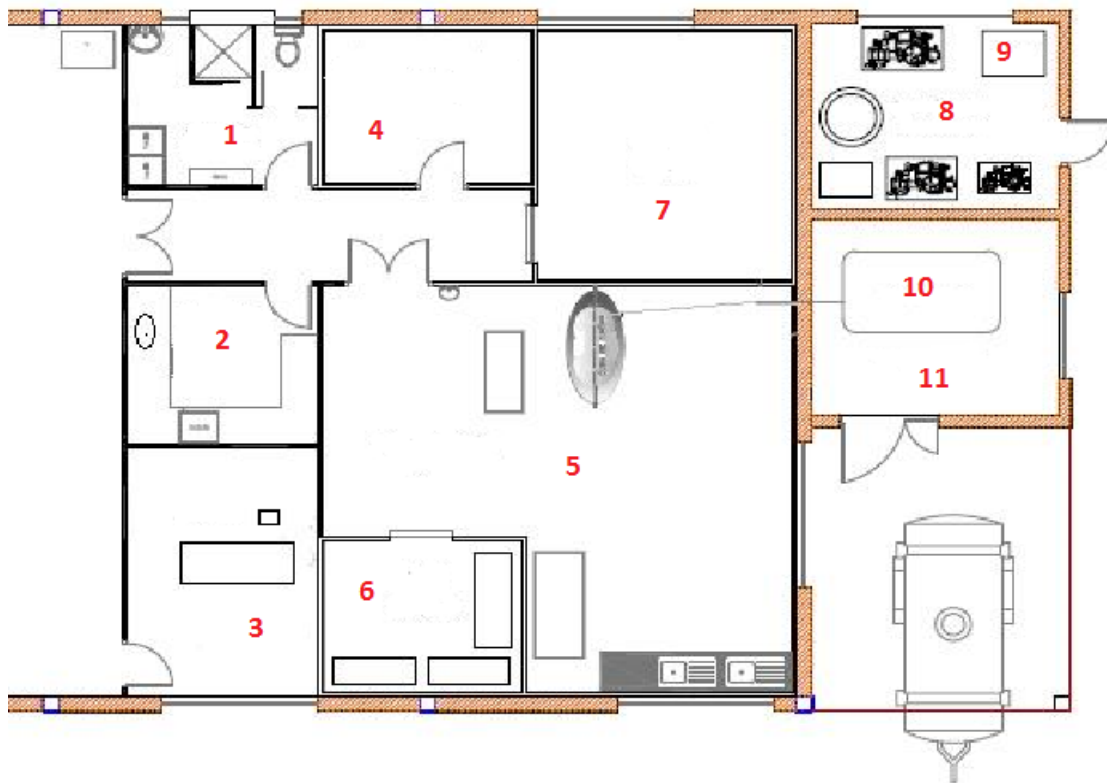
Plano de la planta de la quesería "Ca Llechi".
